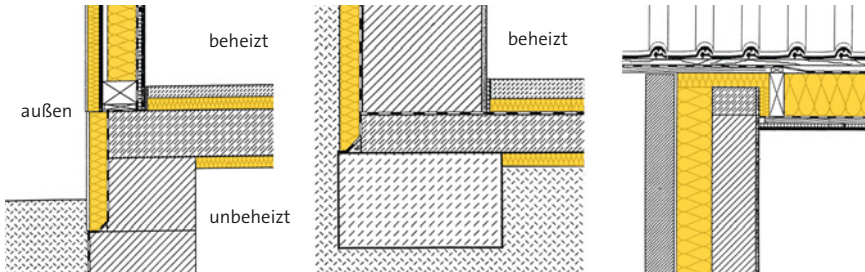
Wärmebrückendetails nach DIN 4108 (Beiblatt 2) a) links) Anschluss Holzaußenwand zur Kellerdecke b) mitte) Gedämmte Massivwand zur Bodenplatte c) rechts) Ortgang-Detail
